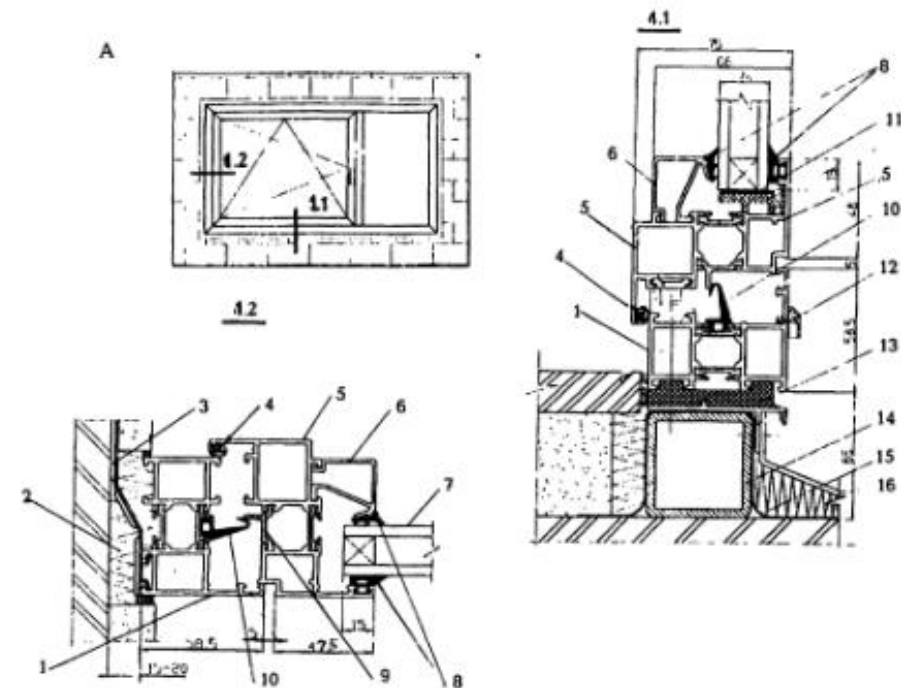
Спаренный оконный блок из алюминиевых профилей: А - схема установки окна в проём; 1 - коробка оконного блока; 2 - утеплитель; 3 - закладная деталь; 4 - упорный уплотнитель; 5 - переплёт; 6 - штапик; 7 - стеклопакет; 8 - фиксирующие прокладки; 9 - термомост; 10 - разделительная прокладка; 11 - герметизация фальца стеклопакета; 12 - водоотвод; 13 - пенополиуретан; 14 - стальной профиль; 15 - герметизирующая лента; 16 - слив (оцинкованный стальной лист)
